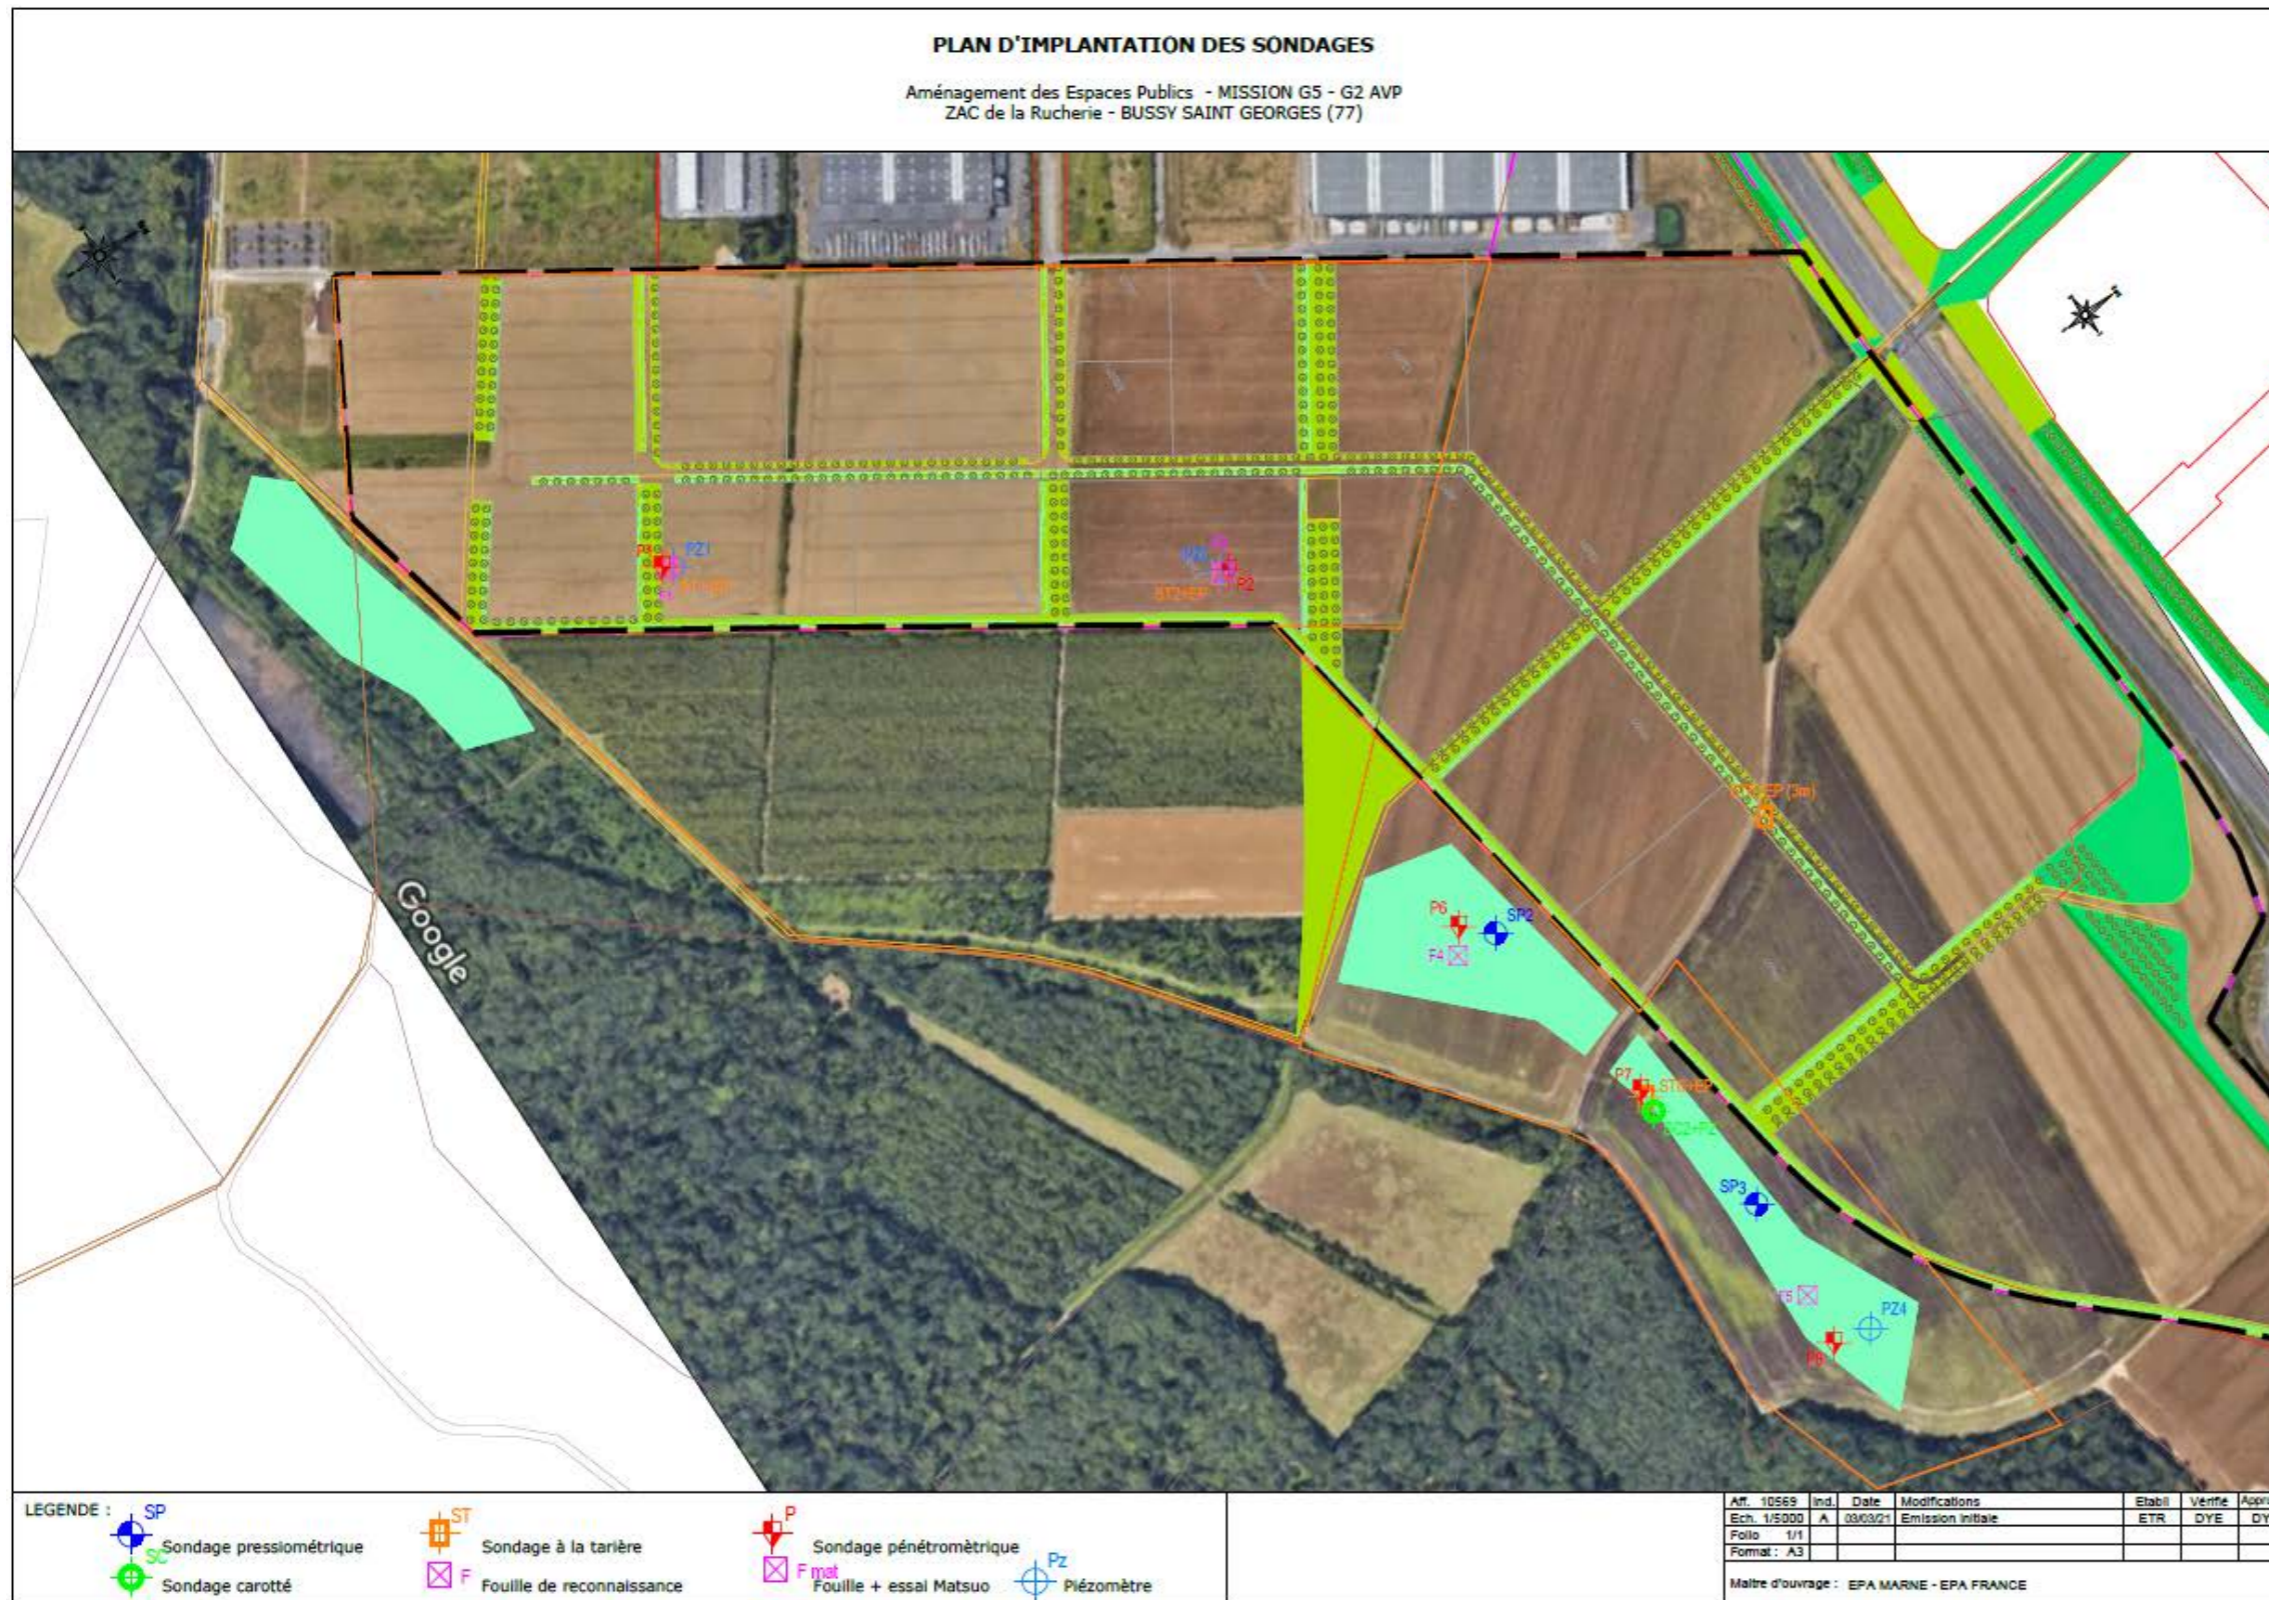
plan d'implantation des piézomètres mis en œuvre dans le cadre du projet (source : SAGA)
